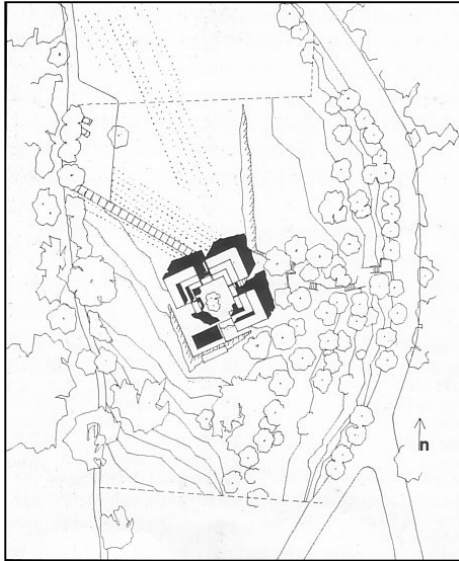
Planta de vivienda aislada en Cataluña. Casa Gibs. Fuente: Chossegros, 1991, p.20
